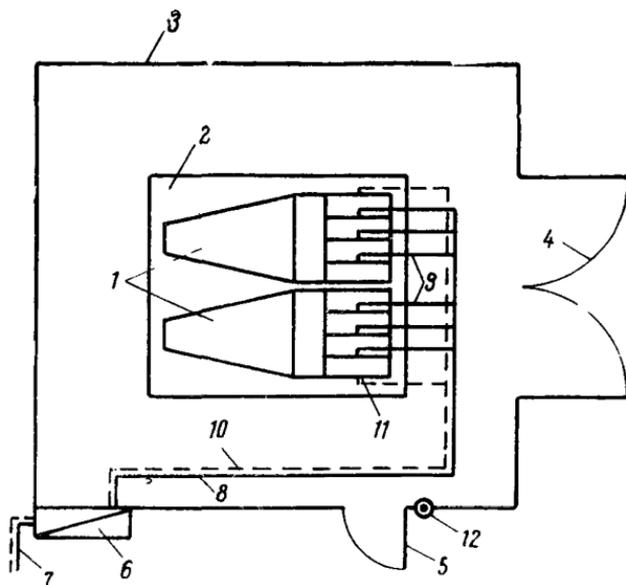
Схема площадки для электроразогрева бетонной смеси
